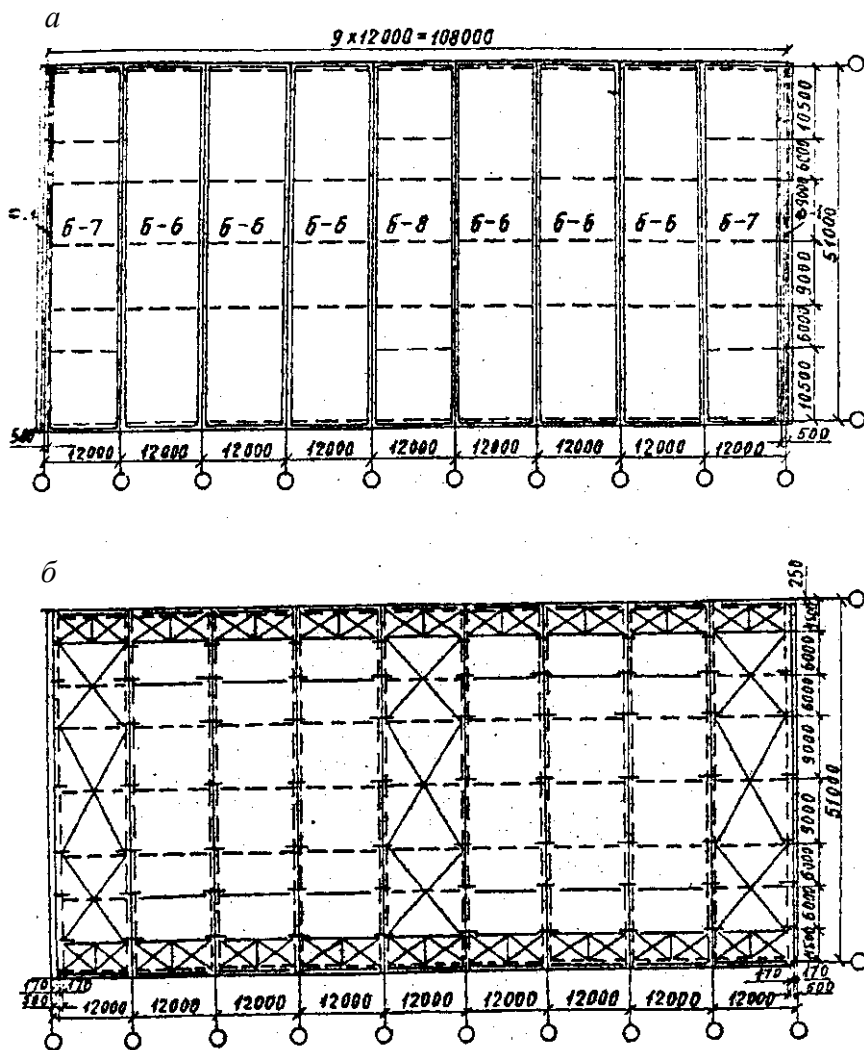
Пример конструкции покрытия с использованием унифицированных стальных ферм для крупноблочного монтажа:
